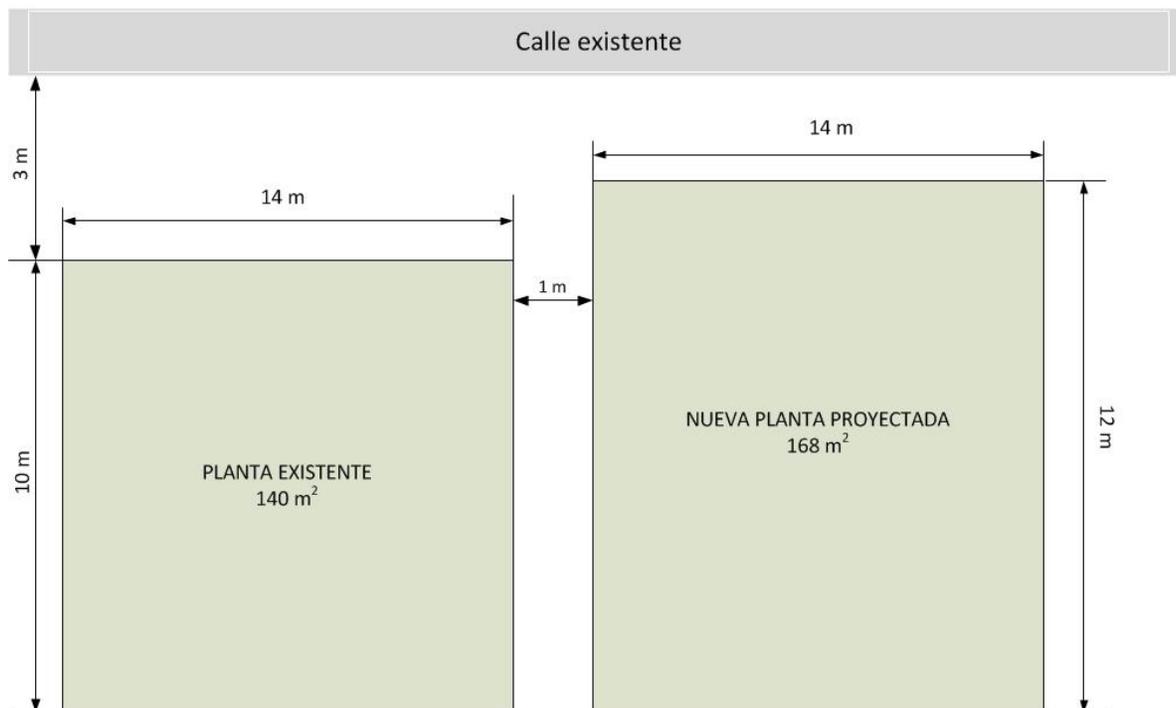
Plan Maestro. Fuente: Elaboración propia
